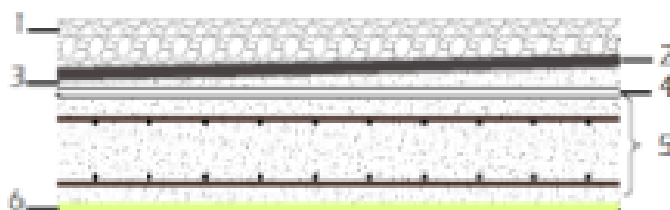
Coupe du plancher terrasse en dalle pleine.
